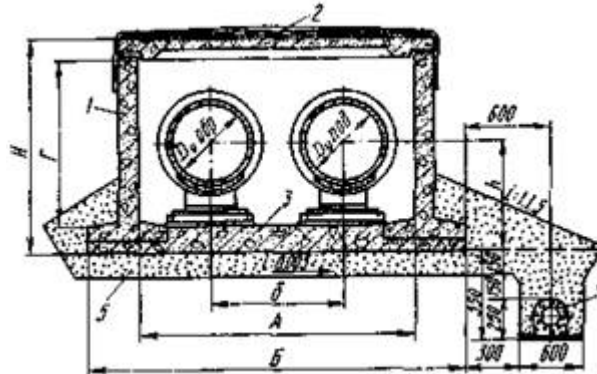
Канал із залізобетонних таврових стінових блоків, ребристих плит перекриття та плит днища з одностороннім дренажем з керамзитобетонних трубофільтрів:
